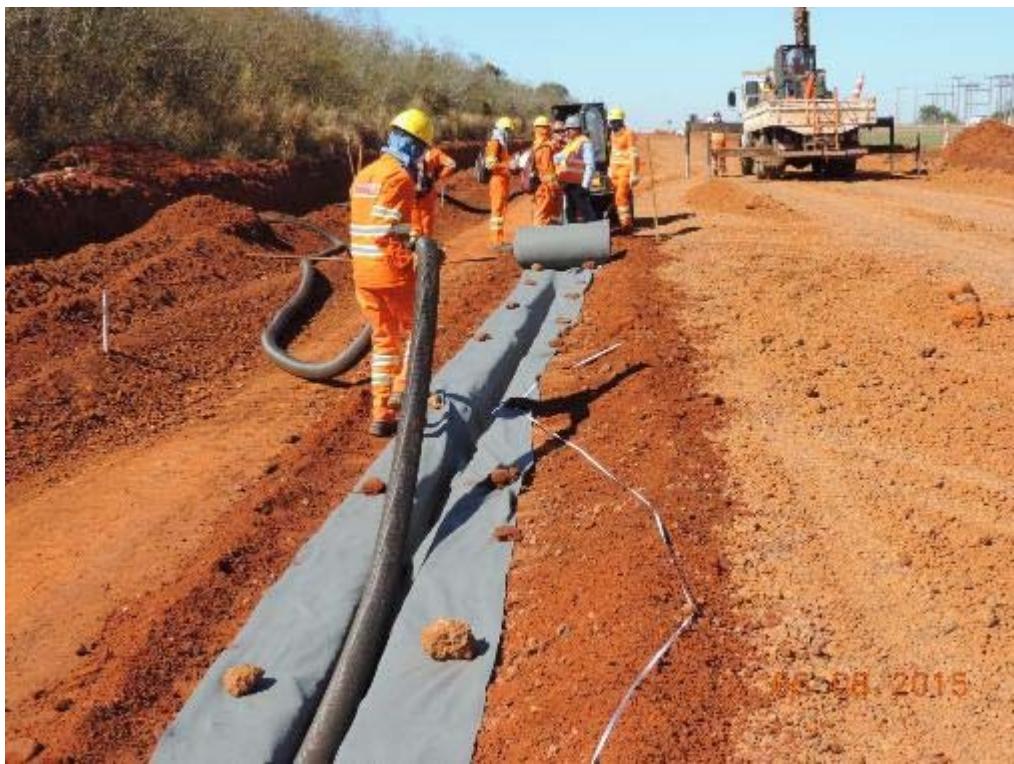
Execução de dreno do pavimento na duplicação – km 21+810.
